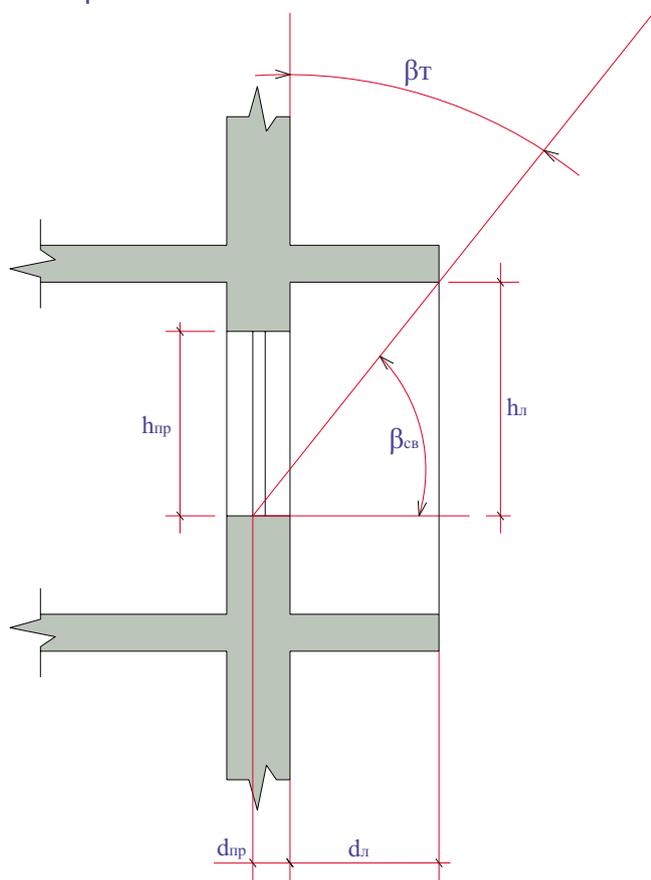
Вертикальный разрез помещения, имеющего светопроем с лоджией
